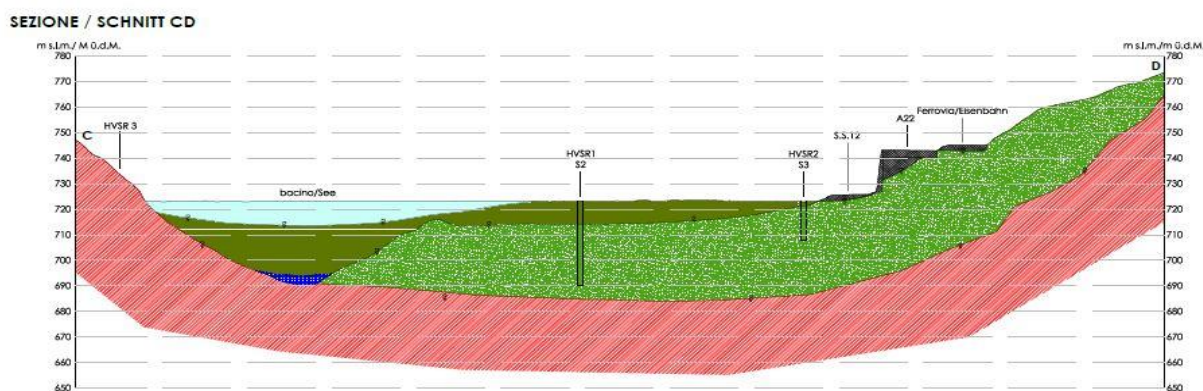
Stralcio dell'Allegato 2 che riporta la sezione CD.
